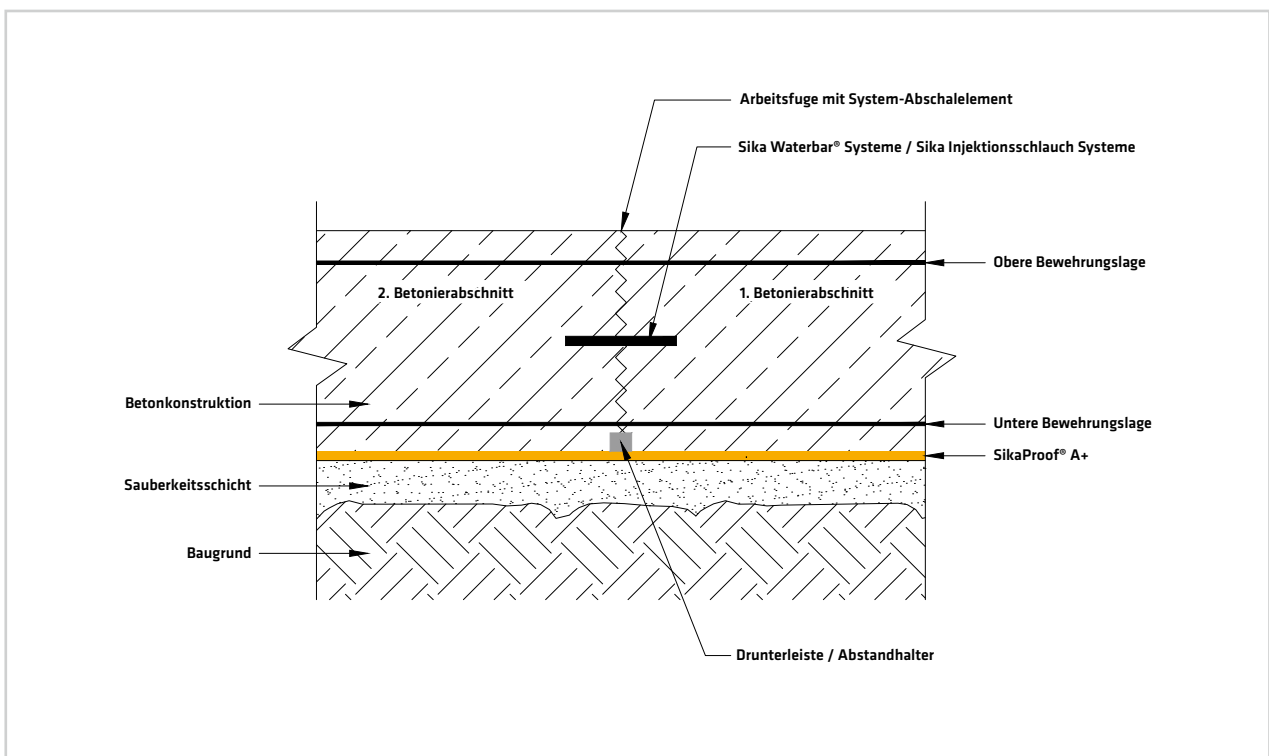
Verlegung auf Sauberkeitsschicht mit Schutzlage
